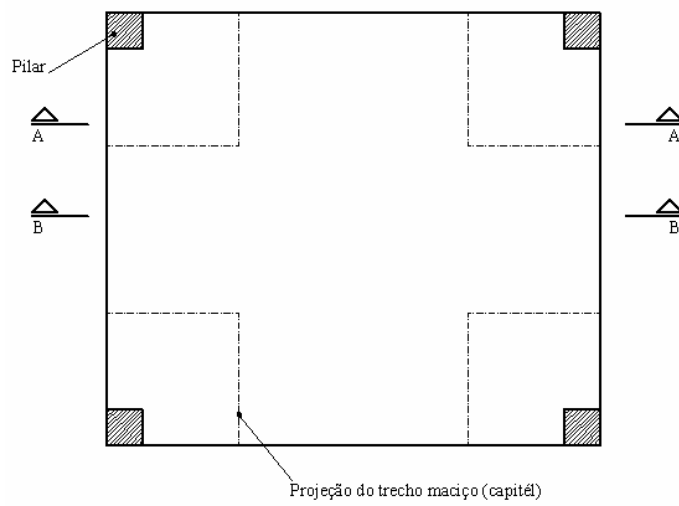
Vista em planta da laje cogumelo nervurada.
